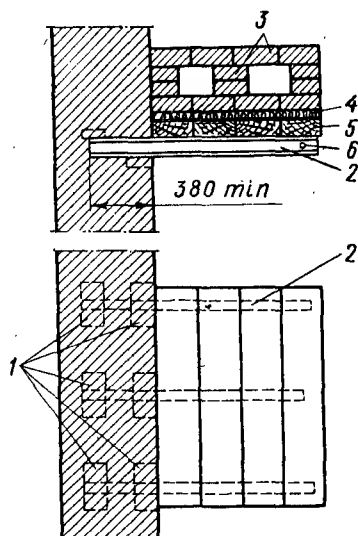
Основание под печь верхнего этажа в каменном здании:
